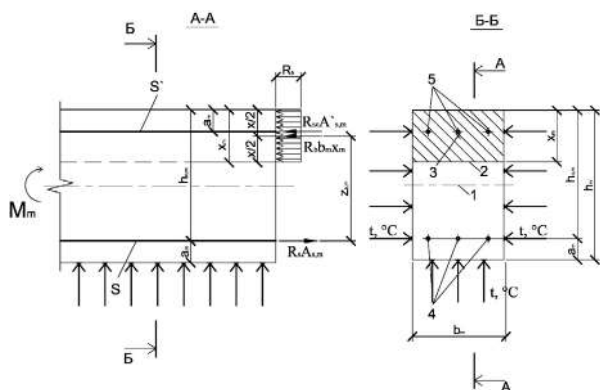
Схема расчета на огнестойкость масштабной модели железобетонной балки прямоугольного сечения с двойной арматурой
